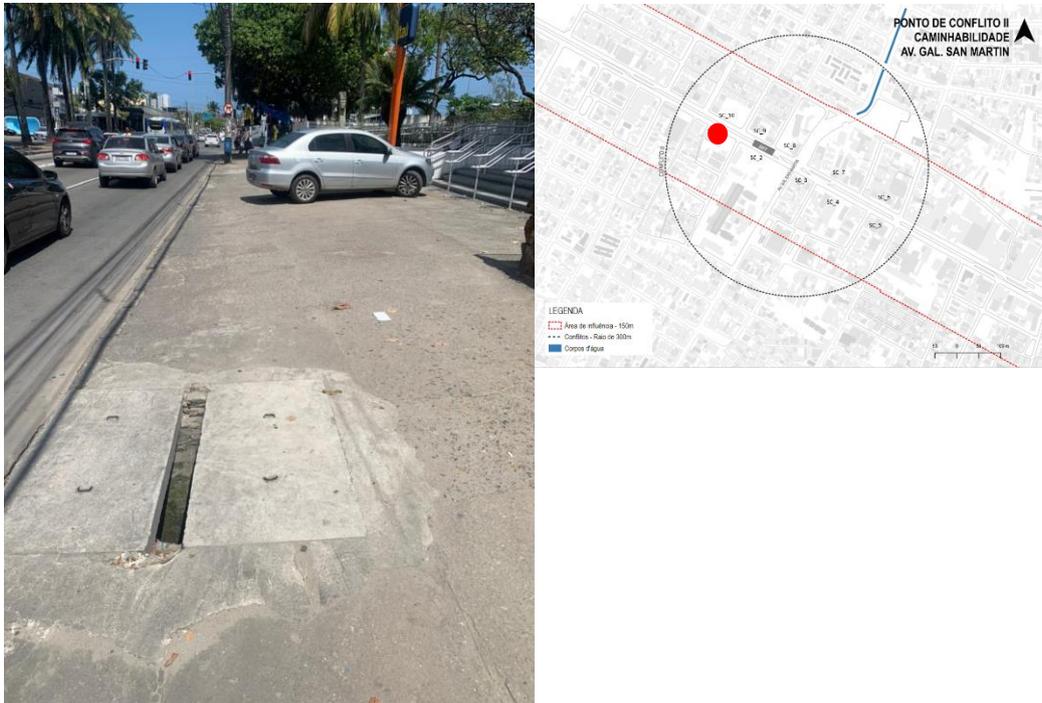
Pavimento deteriorado. Fonte: Acervo próprio, 2022.
